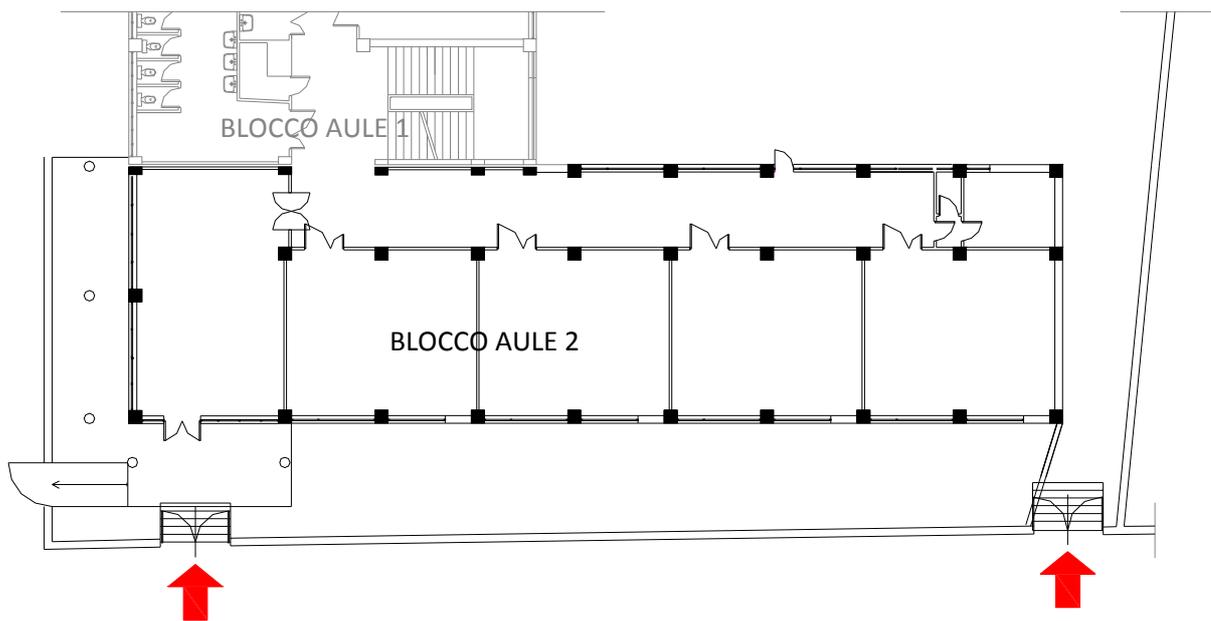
4: Pianta piano tipo del blocco aule 2 (ruotata di 90° rispetto alla planimetria generale di figura 5.1.2).
